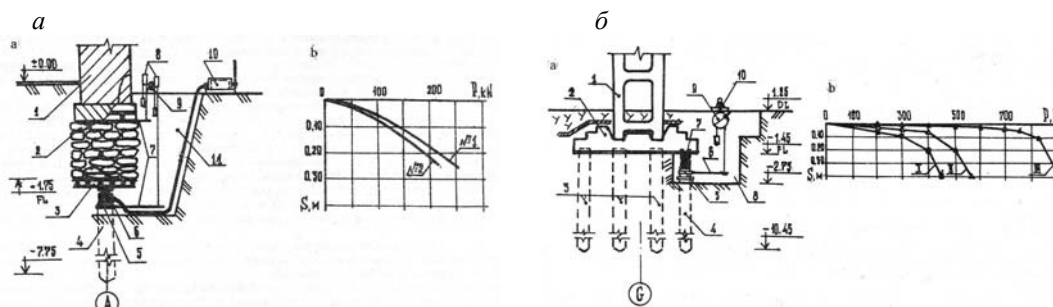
Испытание свай в конструкции фундамента: а – деревянной свай; б – железобетонной свай
